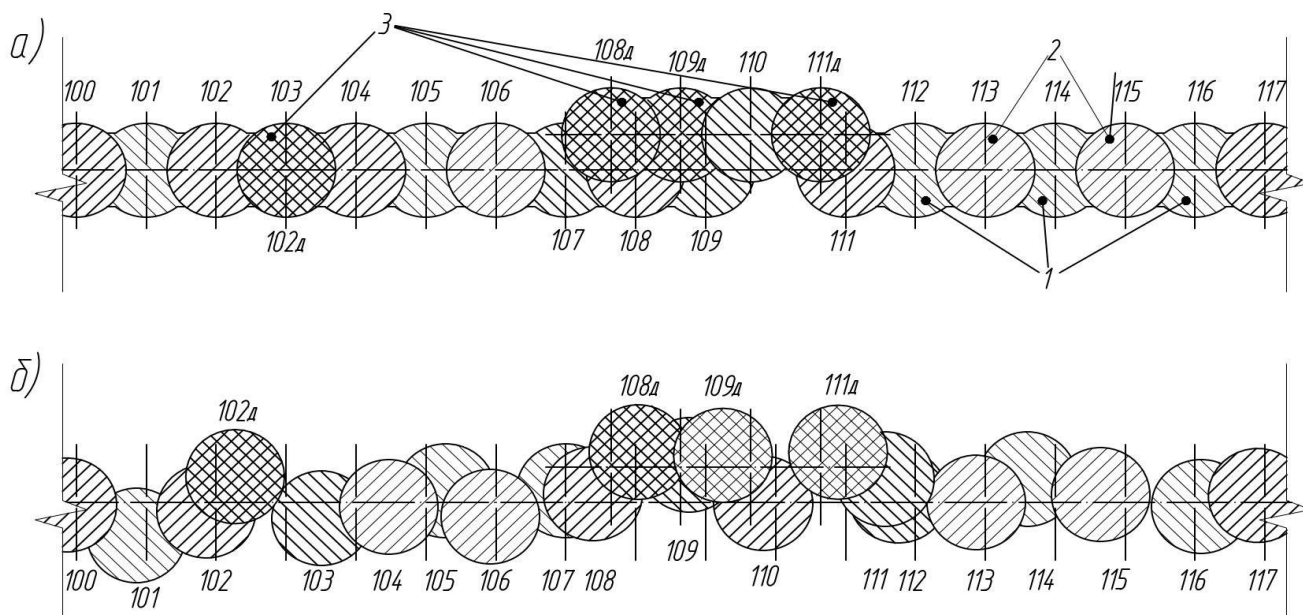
Исполнительный план-срез фрагмента стены в грунте:
